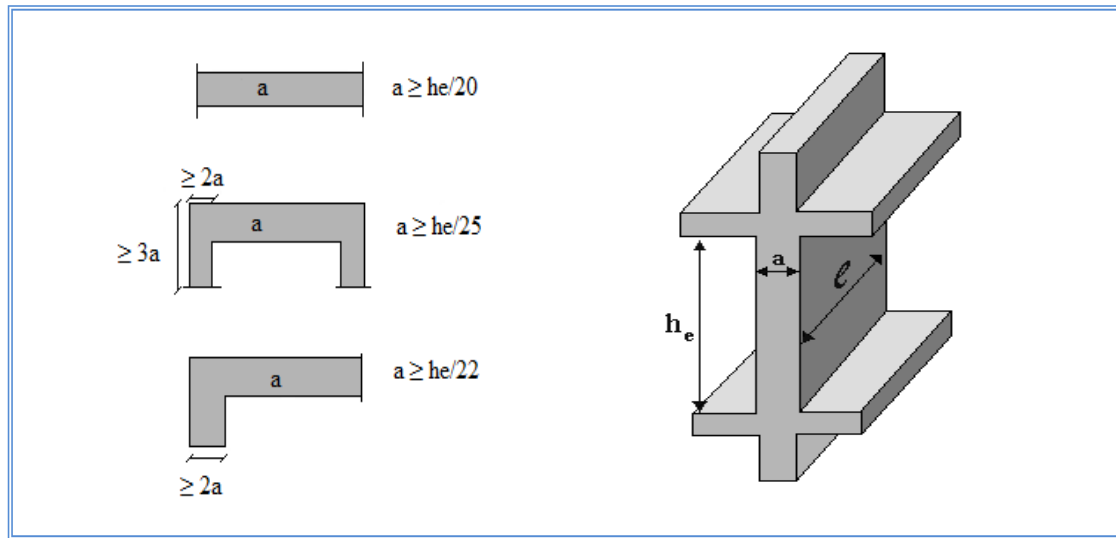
Coupe de voile en plan (gauche) Voile en 3D (droite).
